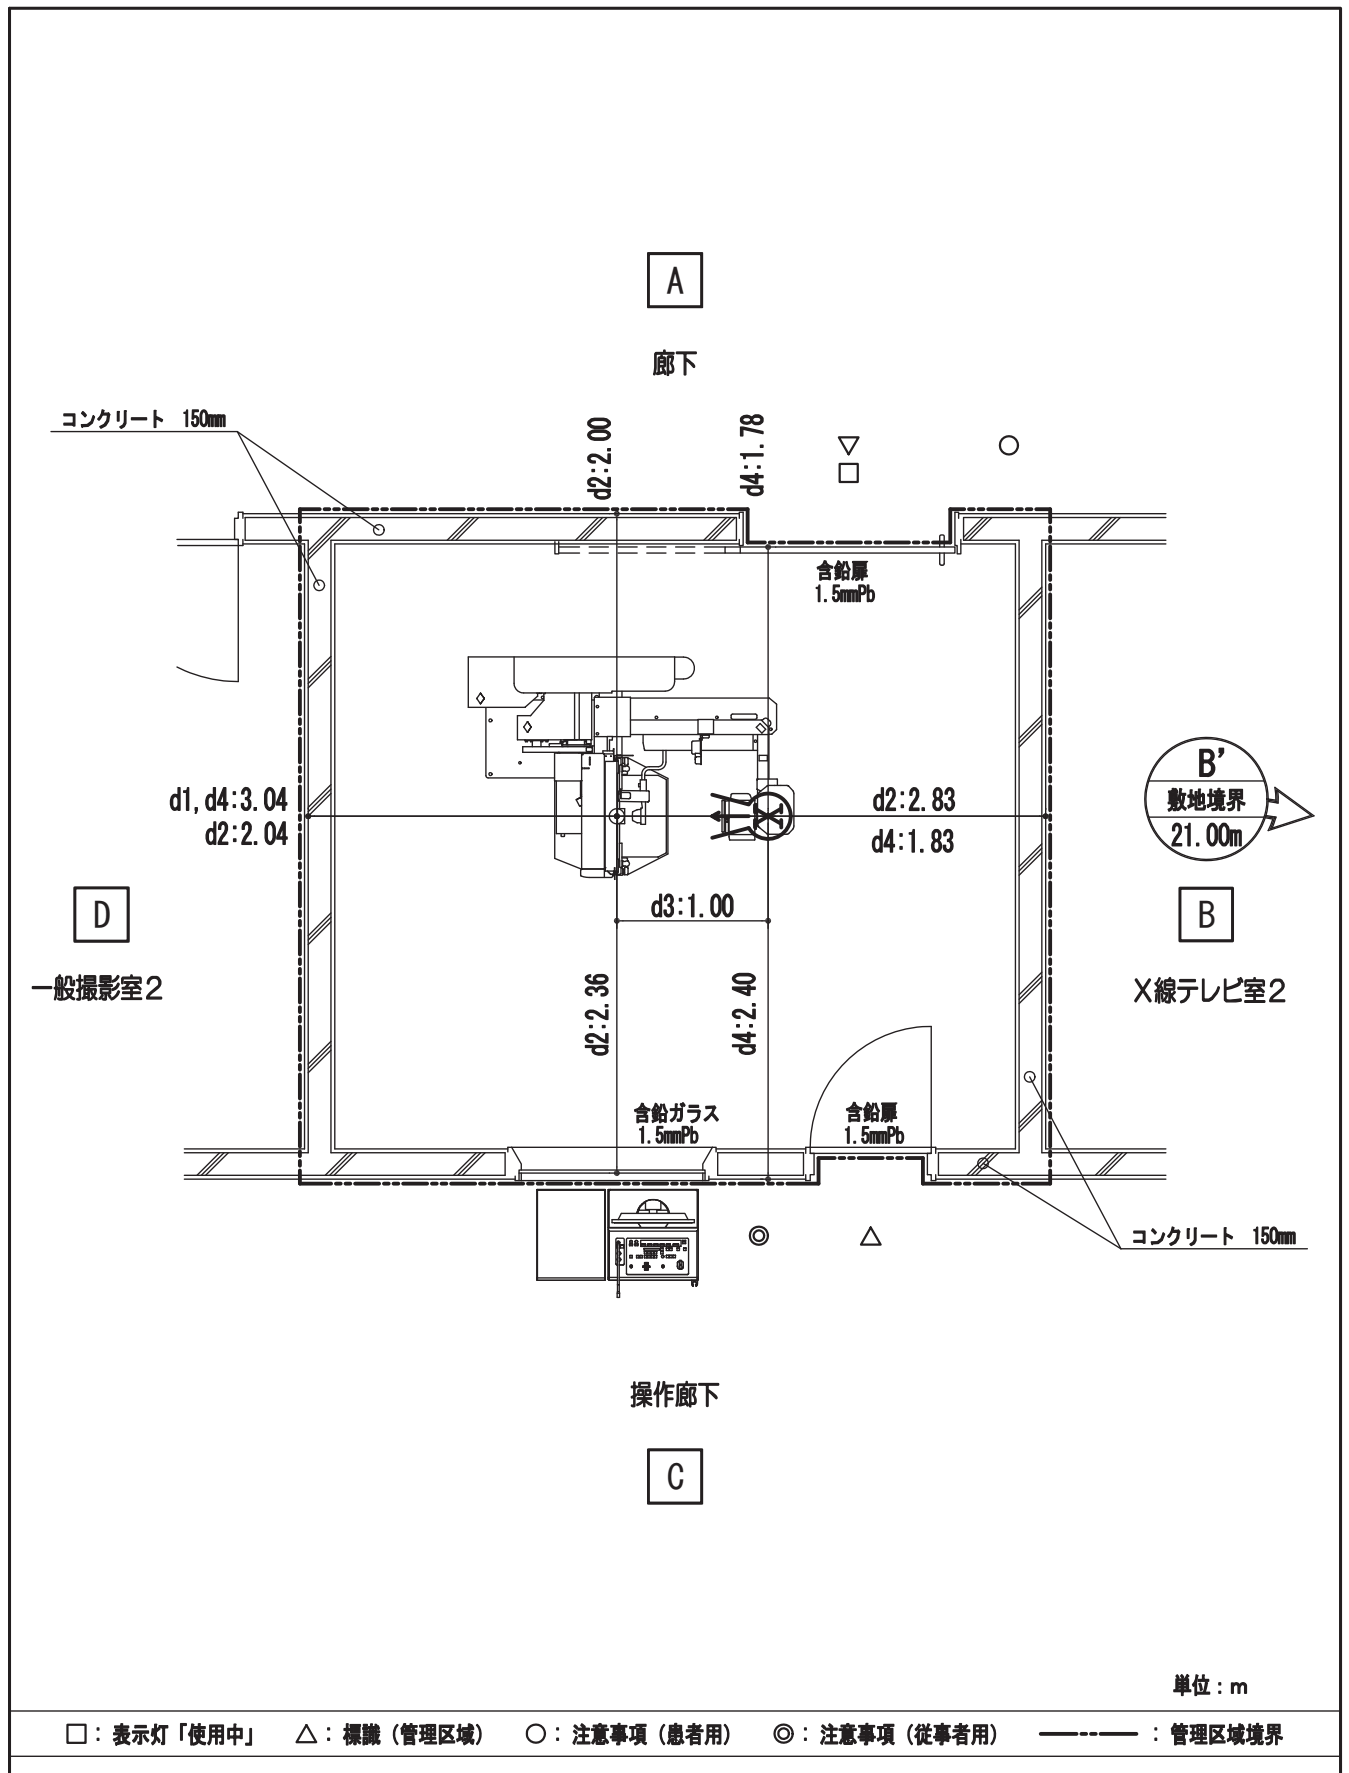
X線テレビ室 立位 透視・撮影 平面図
